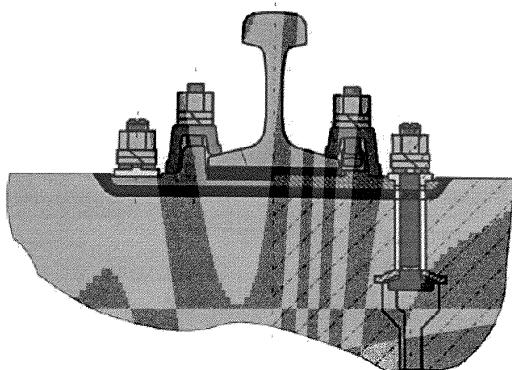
Жесткое раздельное рельсовое скрепление для железобетонных шпал
